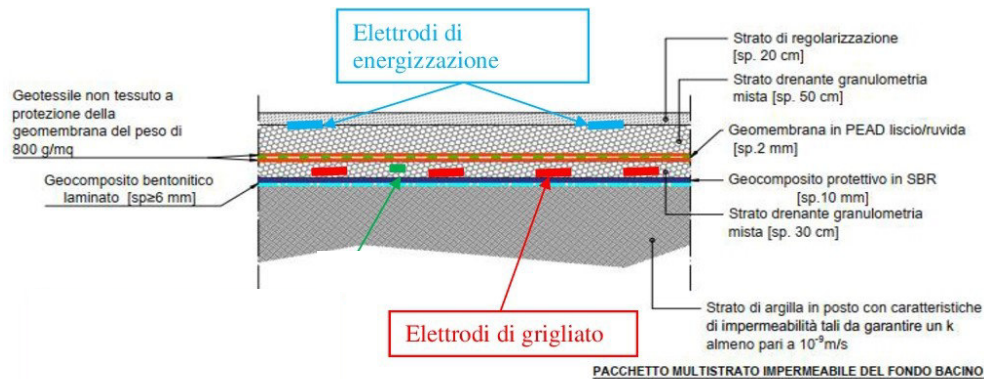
Stratificazione del pacchetto di impermeabilizzazione con la posizione degli elettrodi.
